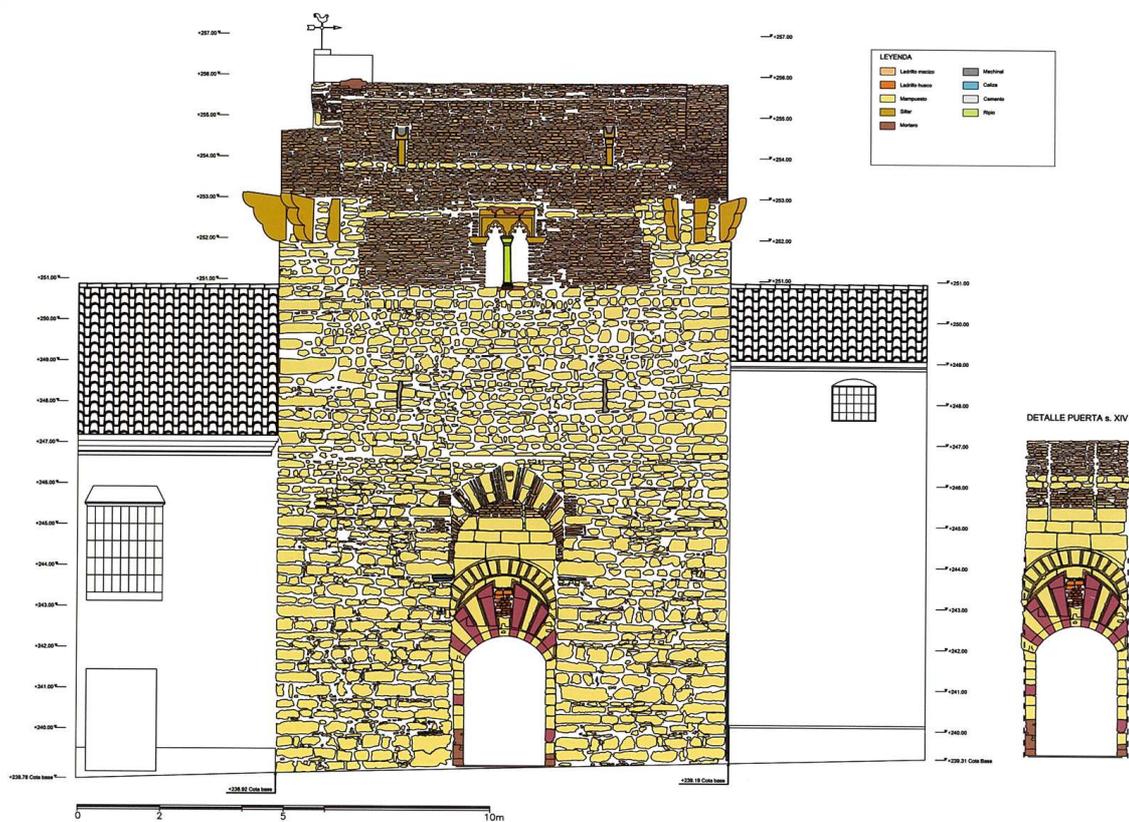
Fábricas empleadas en la fachada principal de la torre del homenaje y detalle de la puerta original del s. XIV.
